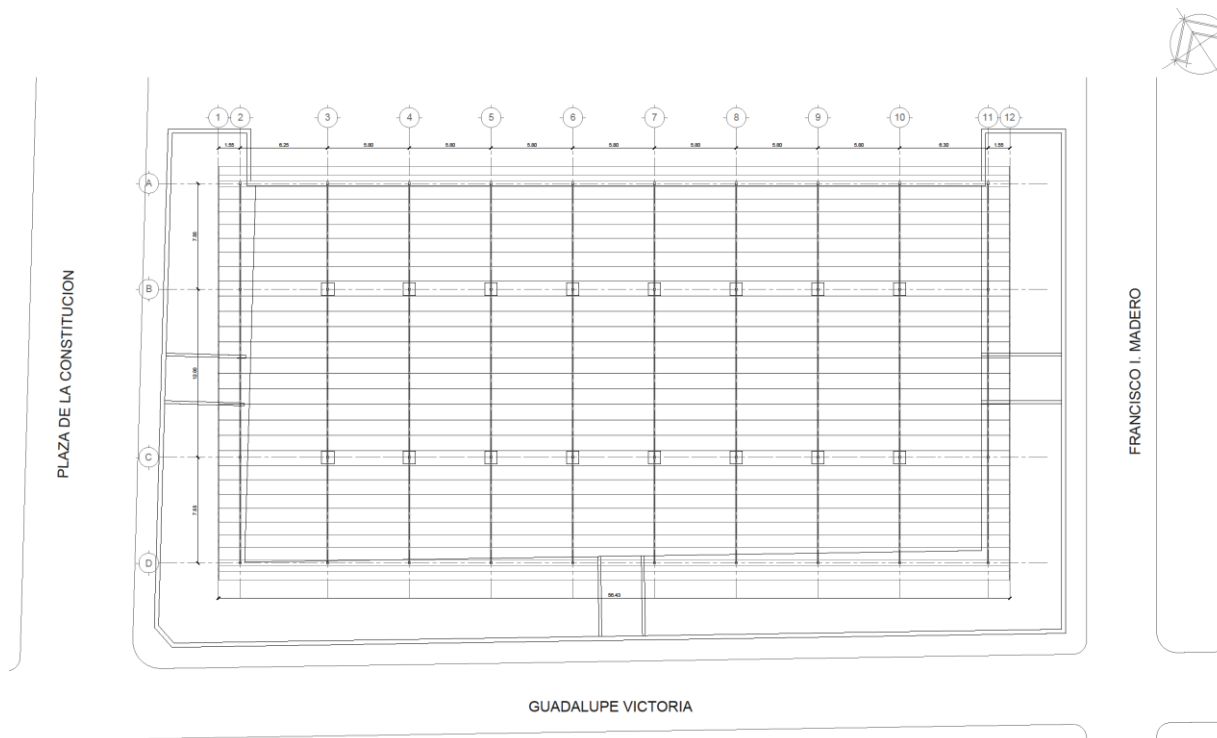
Planta arquitectónica de techos mercado “La paz”
